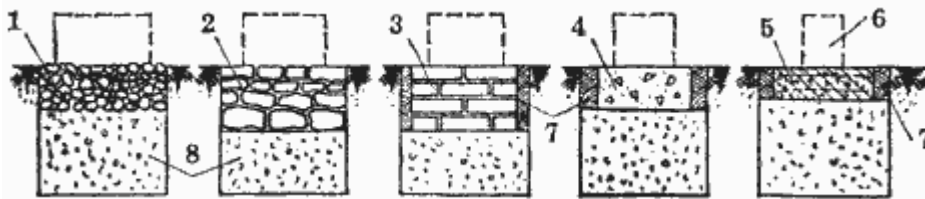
Ленточные фундаменты, устраиваемые в неподвижных (непучинистых) грунтах: 1 - щебень; 2 - бутовая кладка; 3 - кирпичная кладка; 4 - бетон; 5 - железобетон; 6 - цоколь; 7 - глина; 8 - крупнозернистый песок.
